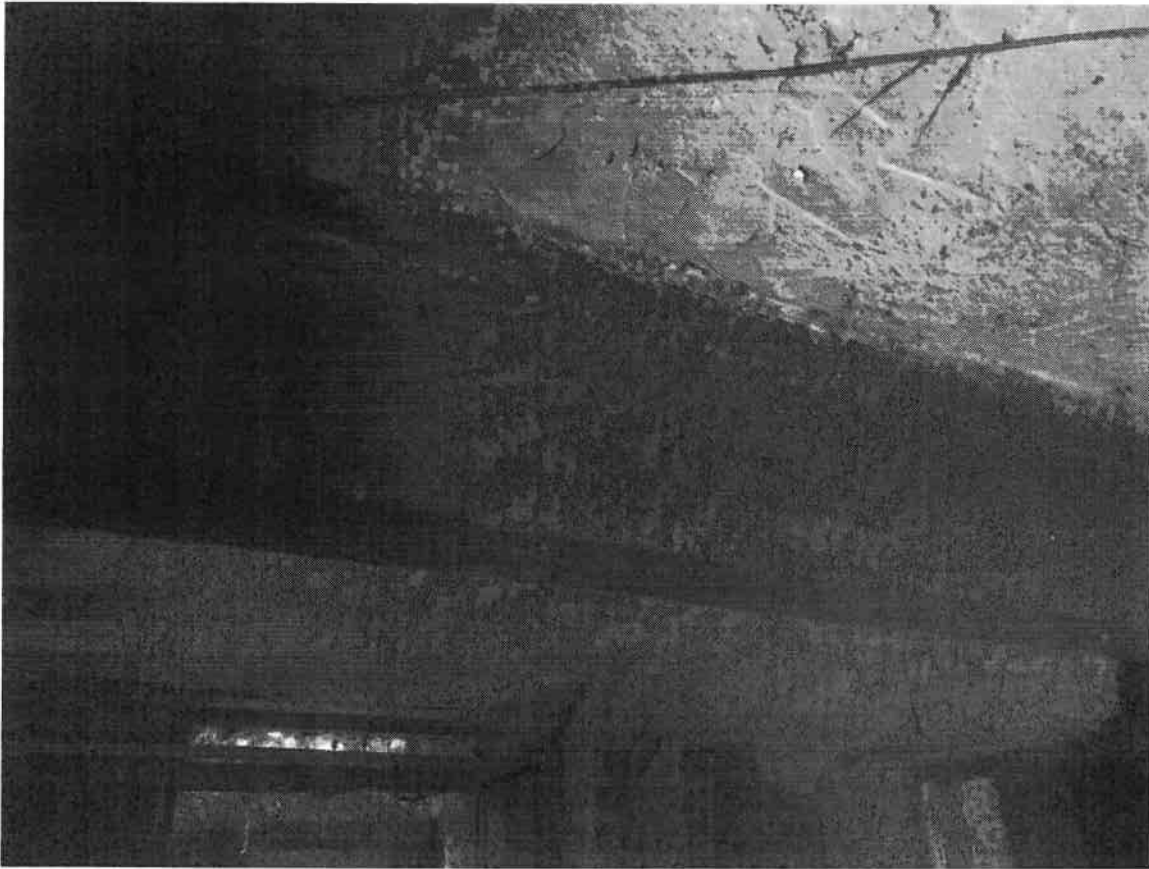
situazione piano interrato durante il sopralluogo del 11.05.2021 – foto 1
